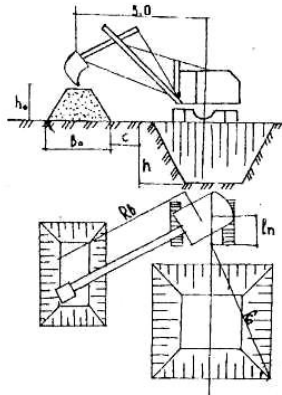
Схема розробки котлованів під окремо розташовані фундаменти експаватором, обладнаним зворотною лопатою
